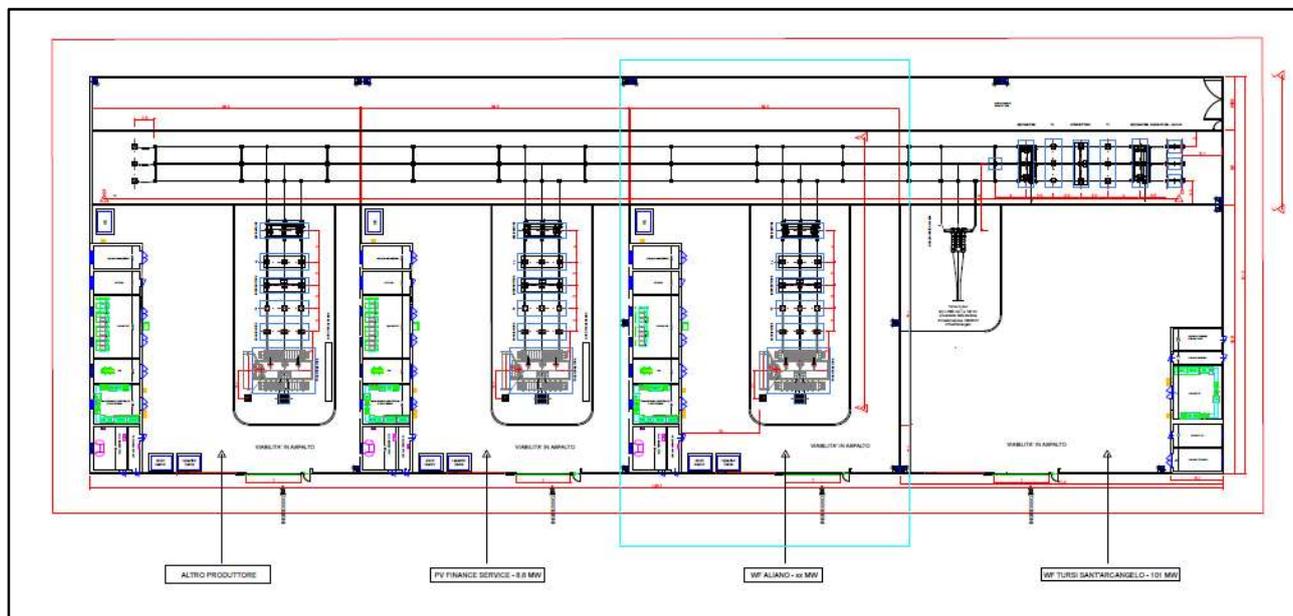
Planimetria elettromeccanica della Sottostazione elettrica condivisa
